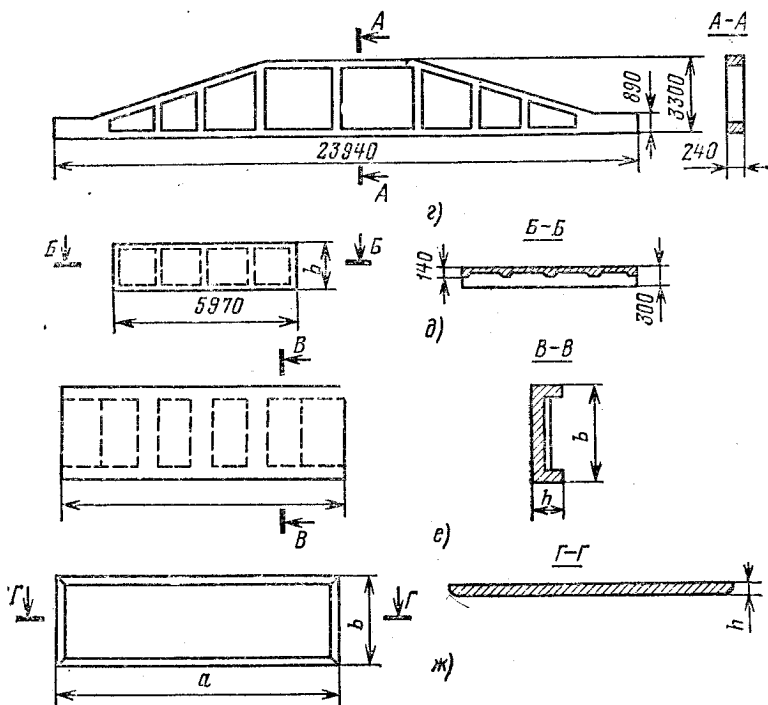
Элементы железобетонных строительных конструкций зданий распределительных устройств (расстояния указаны в миллиметрах)
